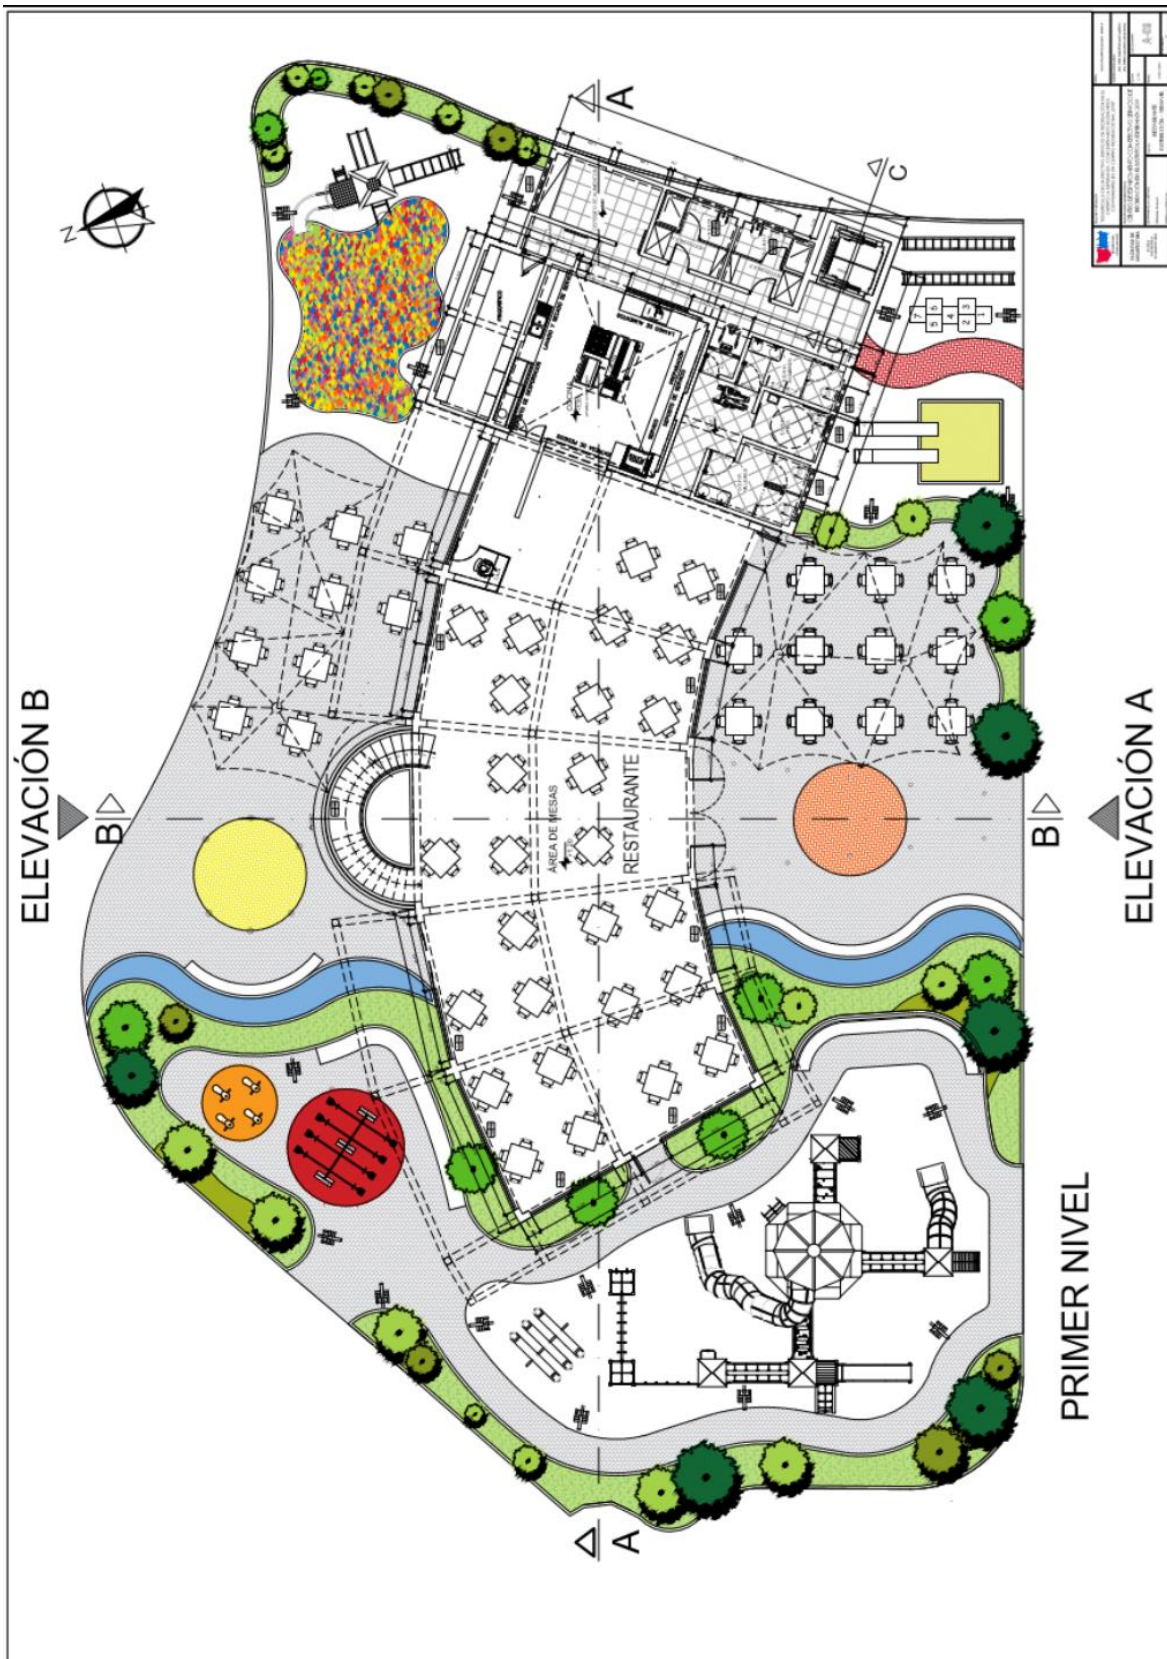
Plano de Restaurante- Distribución 1er piso. Elaboración propia.
